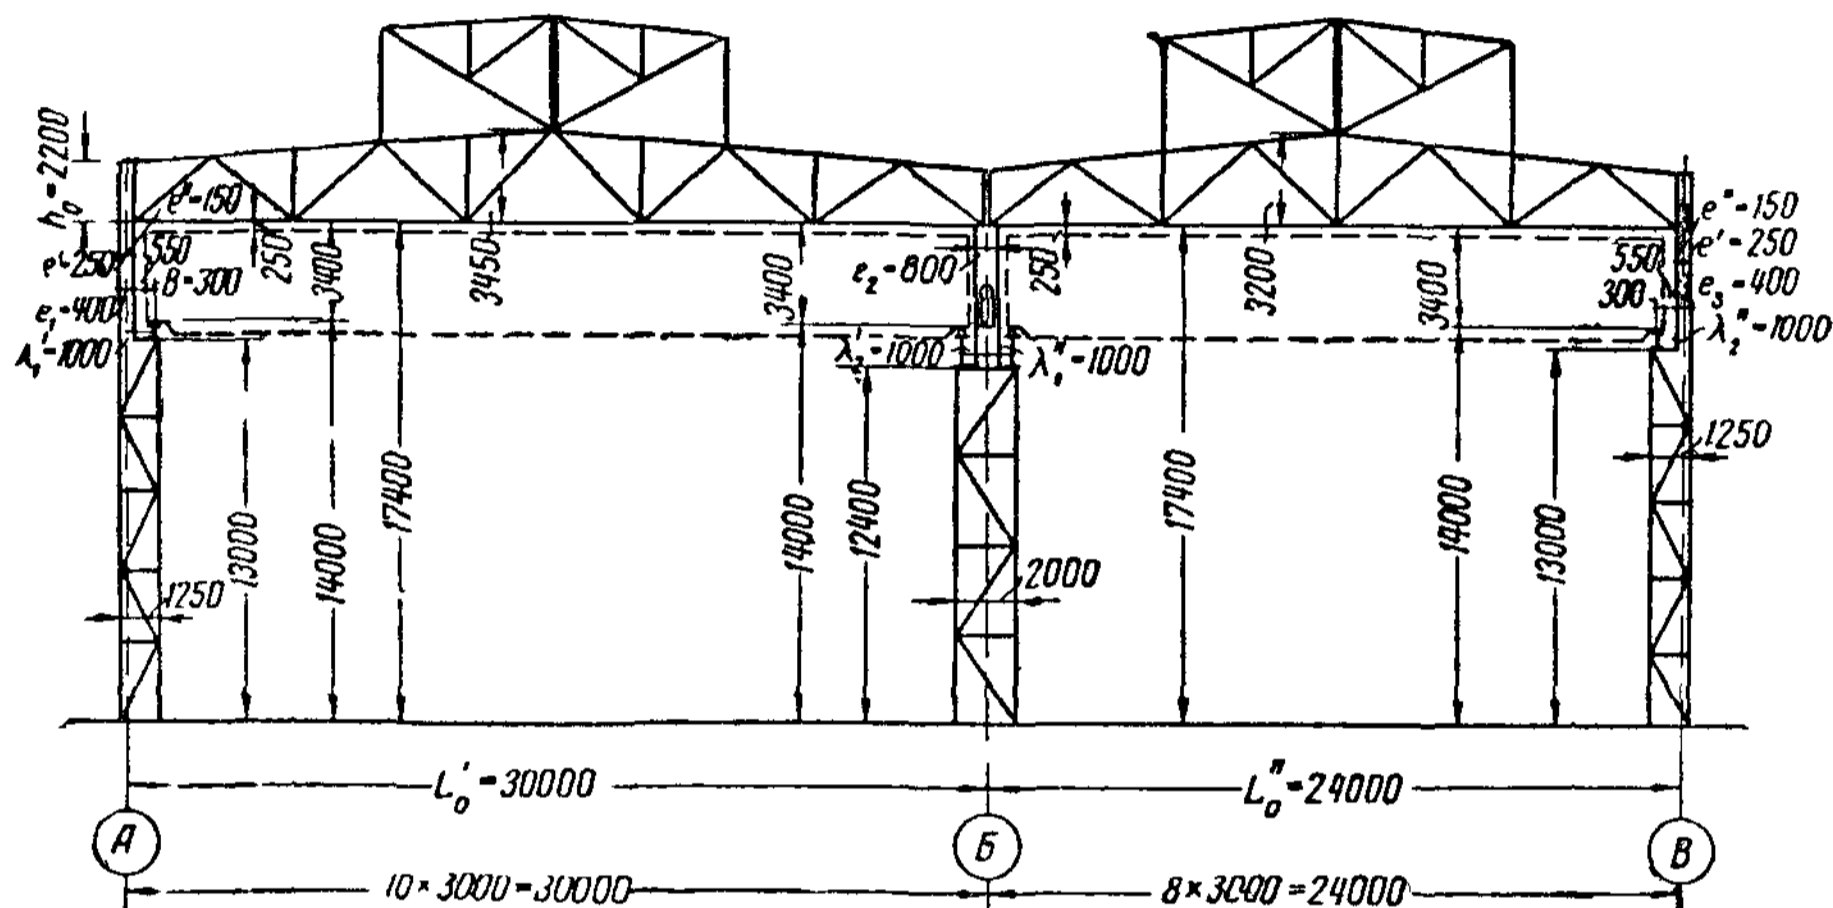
Поперечное сечение цеха (к примеру XII.1)
